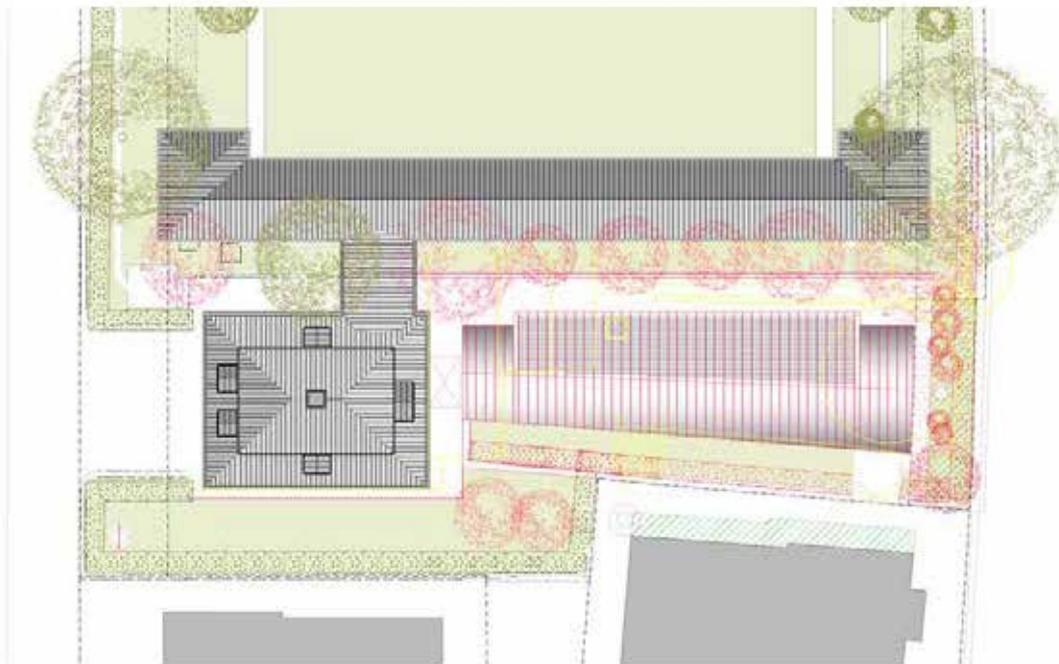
Planausschnitt Dachaufsicht, neue Gebäudeteile und Neupflanzungen rot
